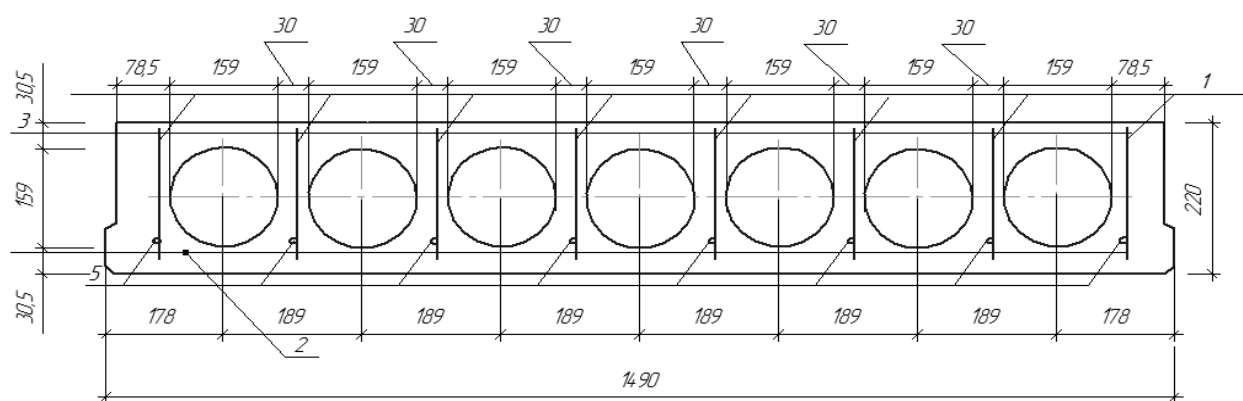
Поперечний переріз багатопустотної плити перекриття
